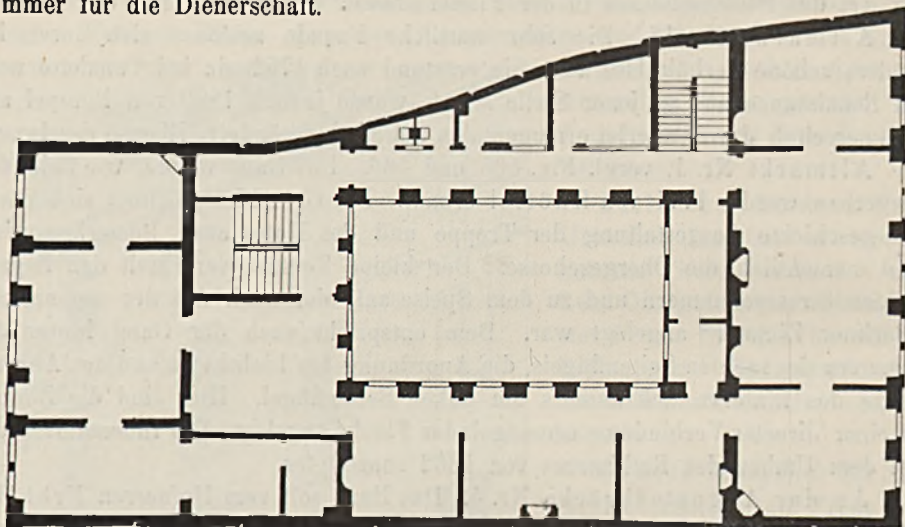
Klostergasse Nr. 4. Grundriss des Obergeschosses.
